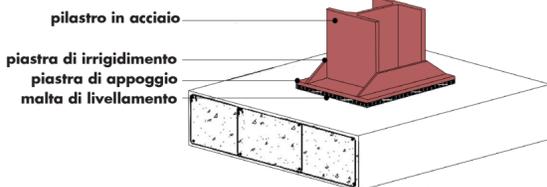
sezione sistema di ancoraggio, SCALA 1:10
